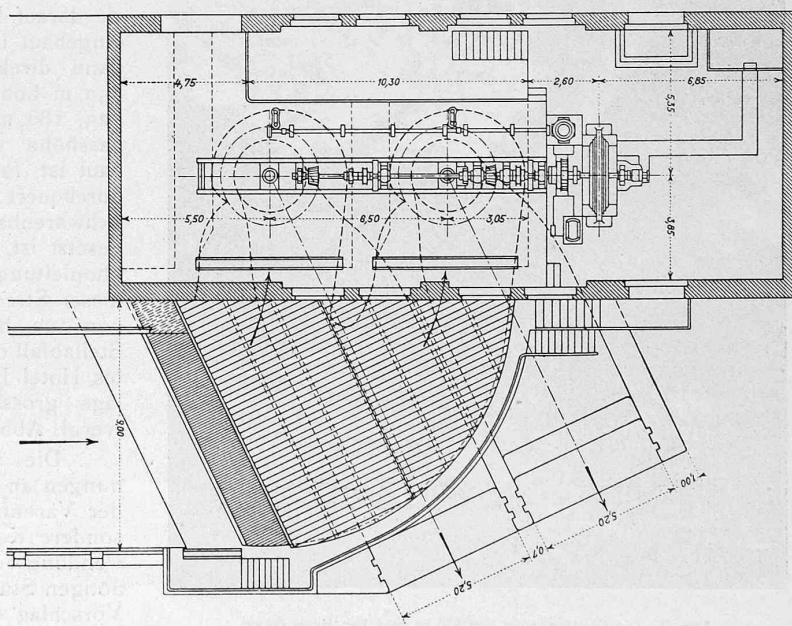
Grundriss der Brunegger Zentrale bei Bruck a. d. Mur. — Masstab 1:250.
